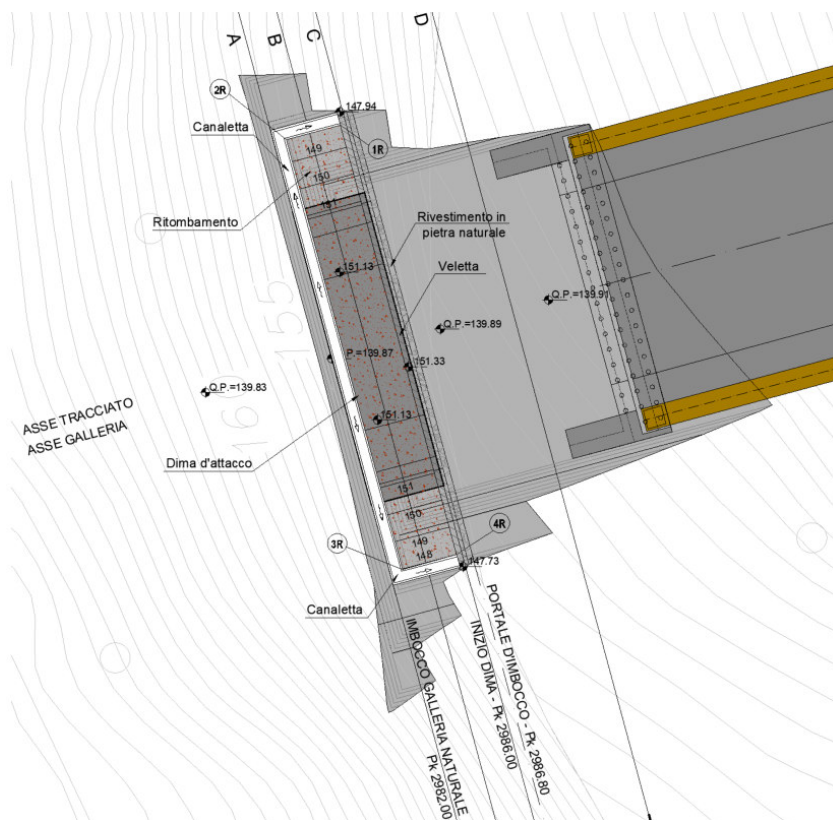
Planimetria tratta artificiale – Galleria Montebonello - Imbocco Nord
